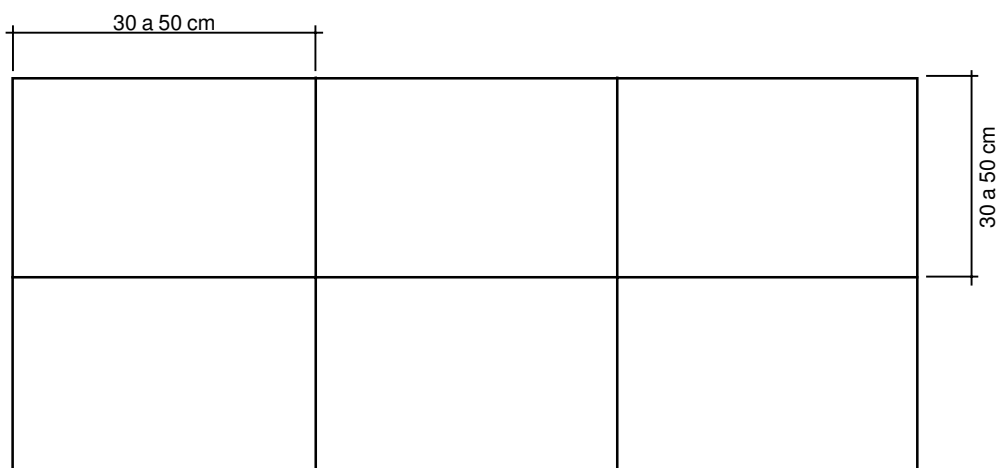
Ilustração esquemática de área de ensaio, com dimensões típicas definidas para a inspeção detalhada (EPUSP, 1995).
